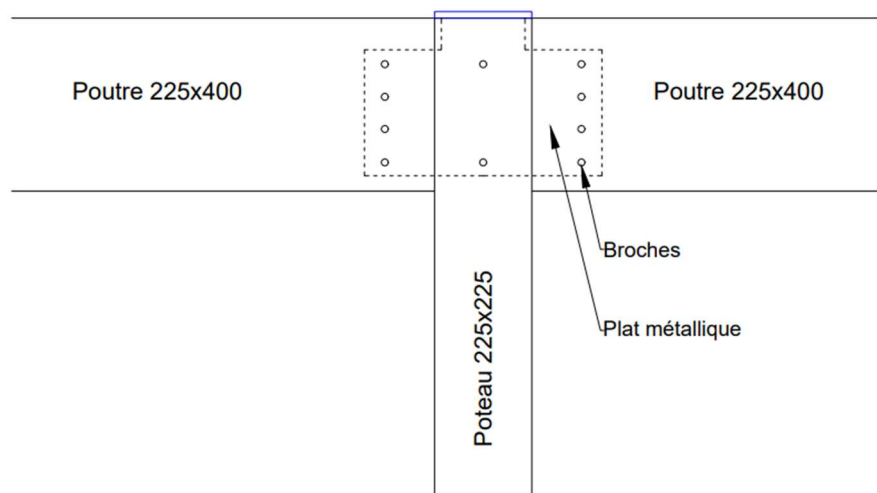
ASSEMBLAGE POTEAU POUTRE/ ZONE DES LOCAUX ASSOCIES
